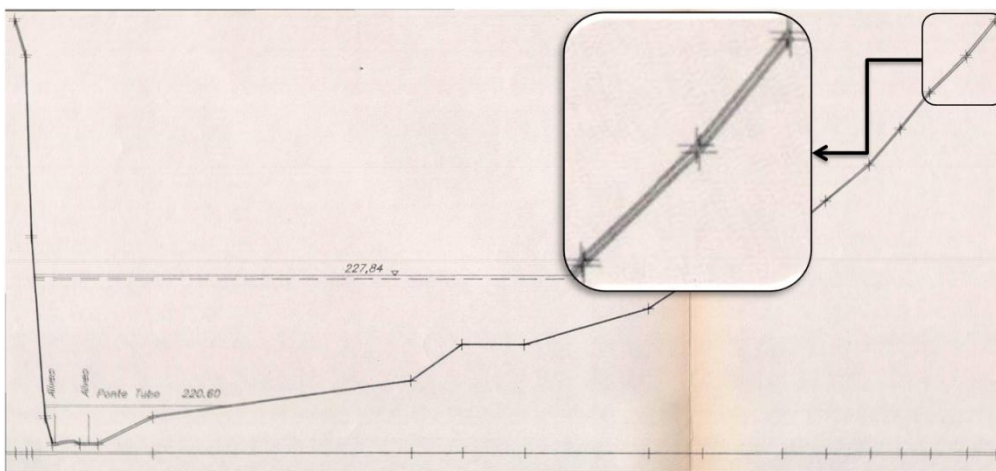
Sovrapposizione della sezione originale con quella raddrizzata (scenario di piena per ipotetico collasso)
